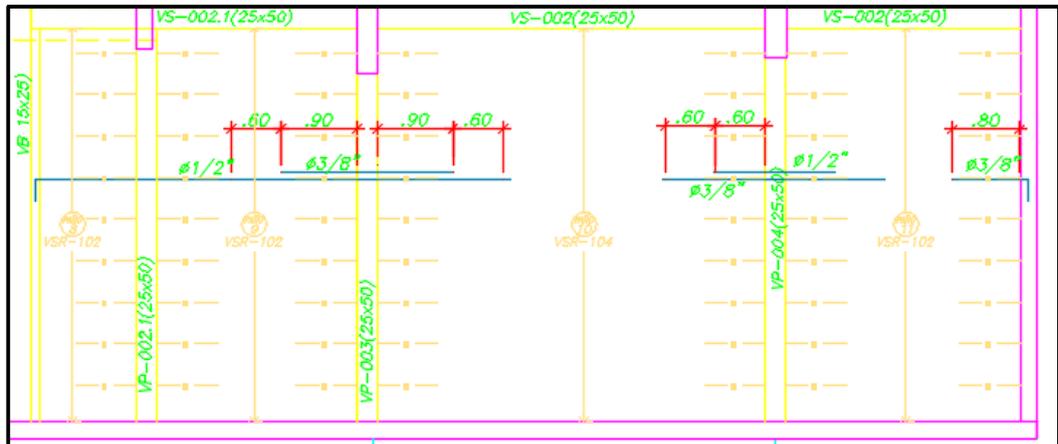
Detalle del sector del plano del sistema de losa aligerada con viguetas pretensadas.
